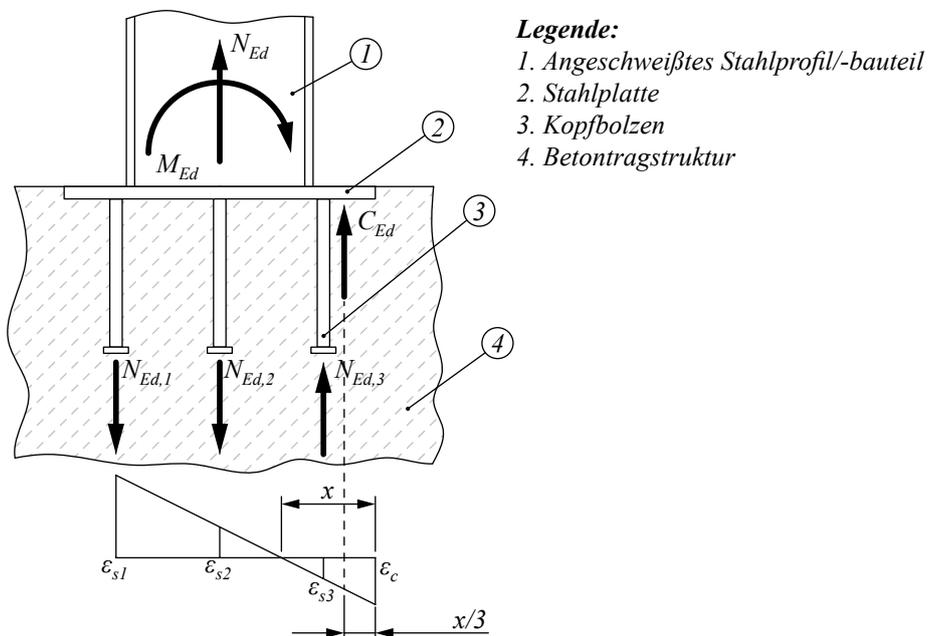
WELDA® Ankerplatten bestehen aus einer Stahlplatte und aufgeschweißten Kopfbolzen
